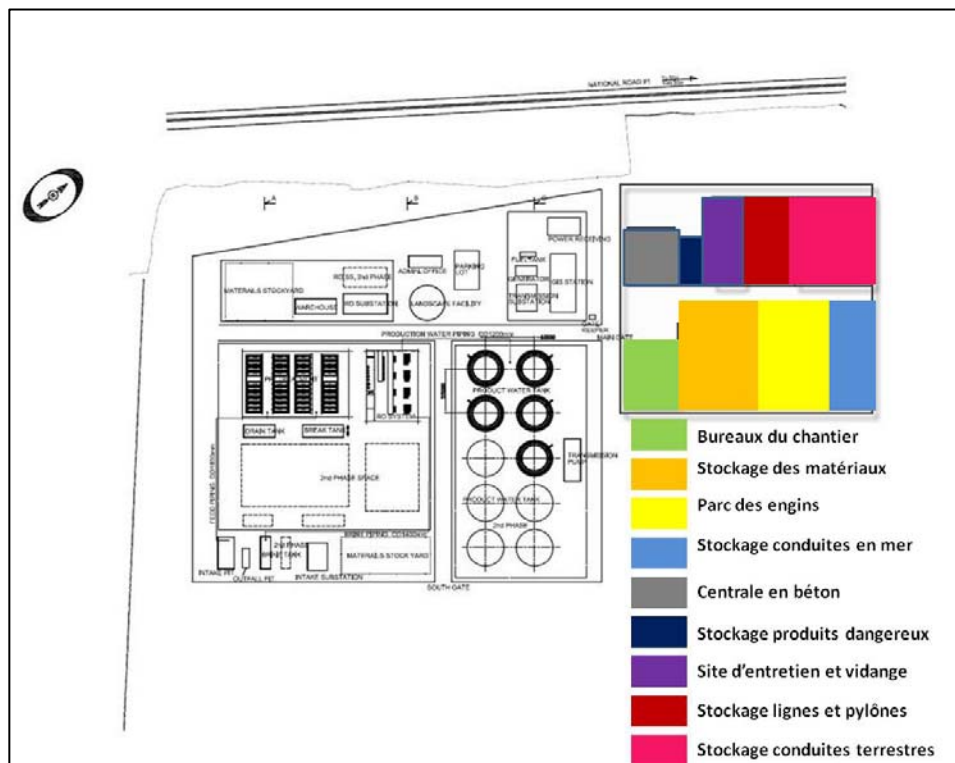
Position du site de chantier pour les travaux de construction de la station de dessalement
